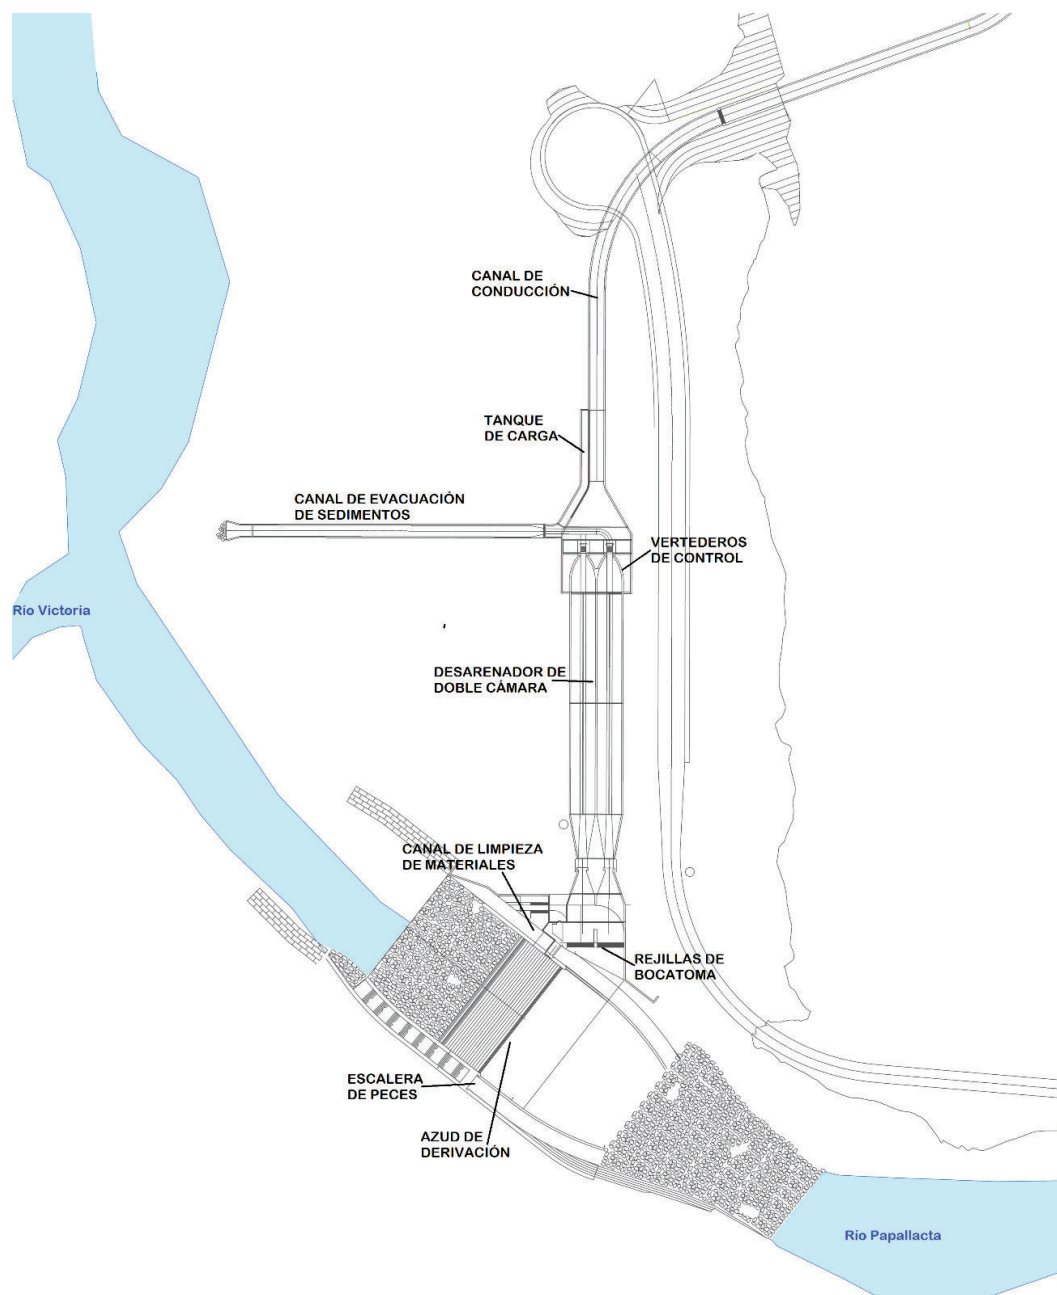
Diagrama de las obras del Río Papallacta ^[39]
